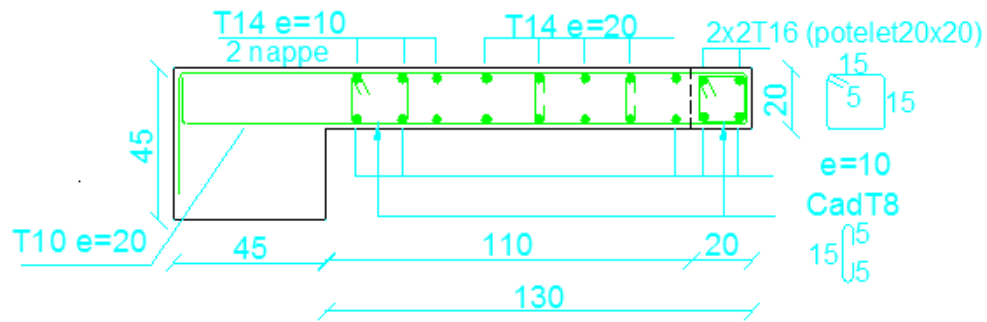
Schéma de ferrailage des voiles type 2 zone 1.
